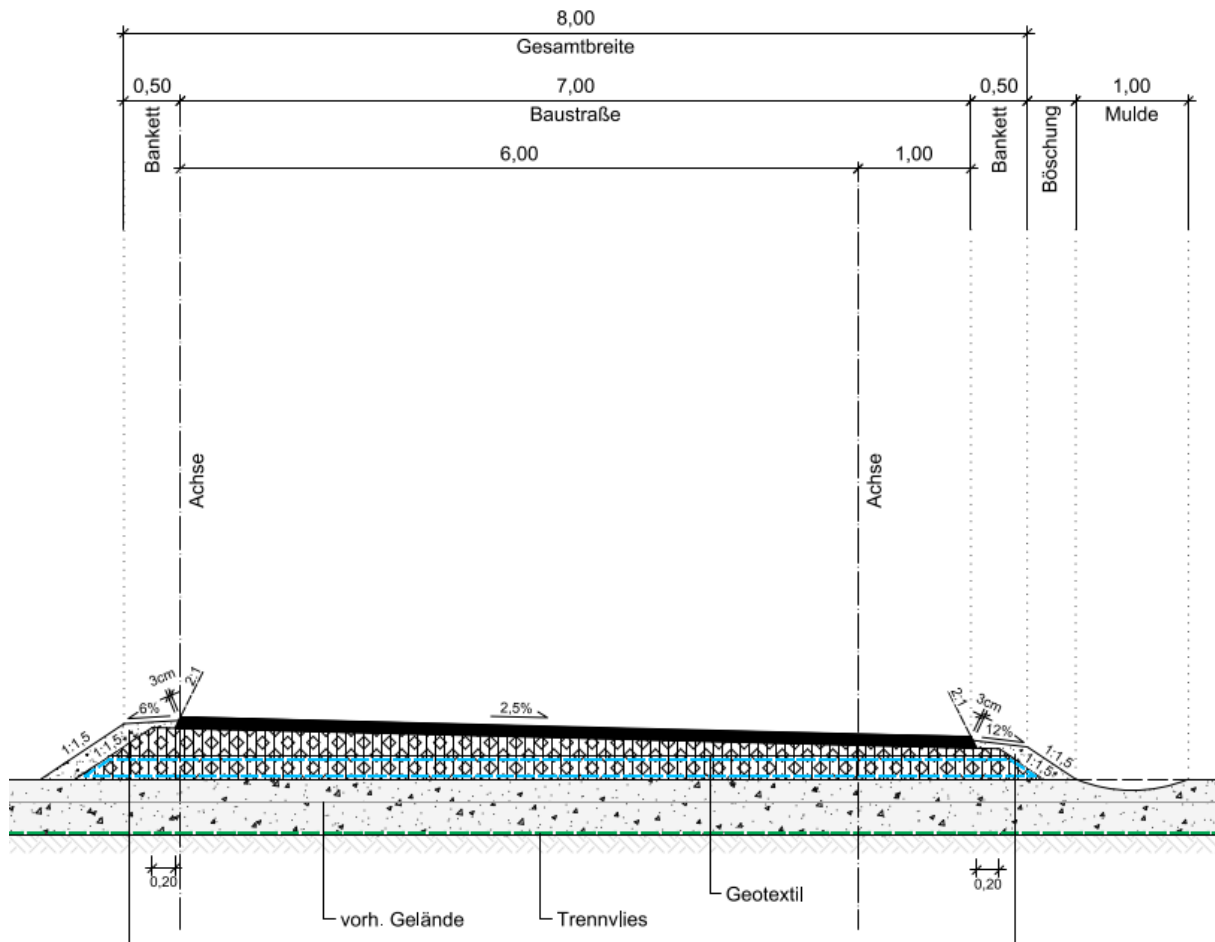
Regelquerschnitt Baustraße SH und NI
